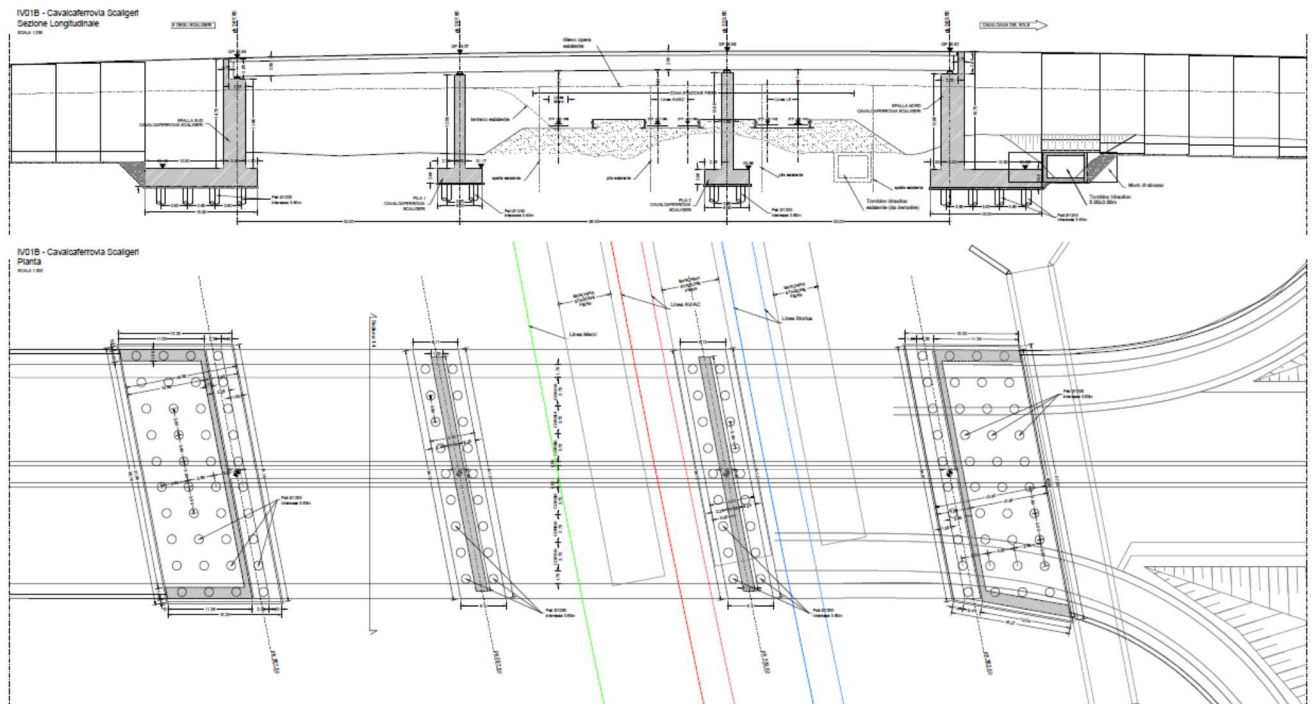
Planimetria e Profilo del Cavalcaferrovia Scaligeri
